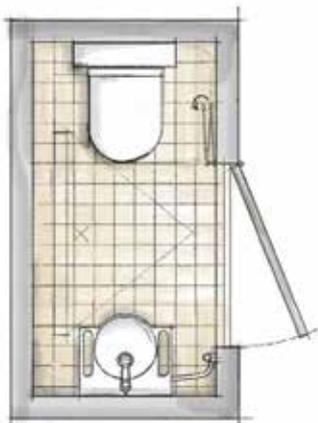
Umbauvariante 2 – Gästetoilette mit Assistenz beim Duschen (Grundriss: DLW)
